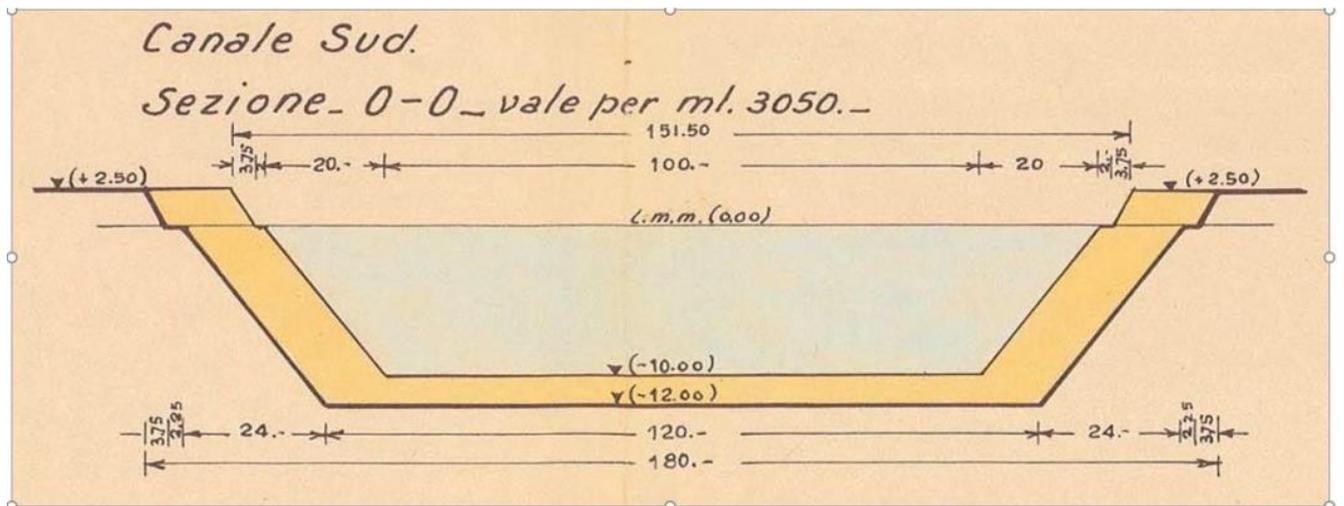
Estratto PRP 1965 – Sezione 0 - 0
